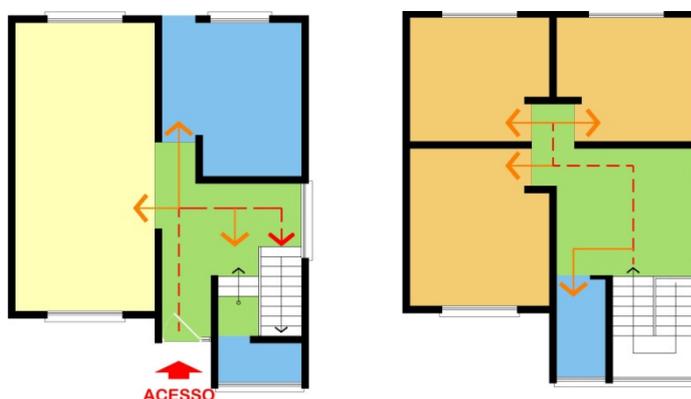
Planta esquemática com a setorização funcional e fluxos de circulação
